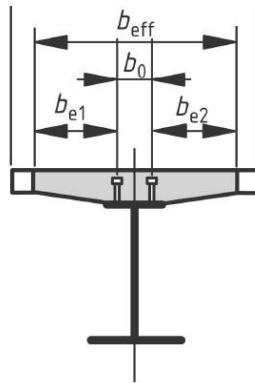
Mitwirkende Breite für Stahl-Beton-Verbundkonstruktionen - b_{eff} [51]
